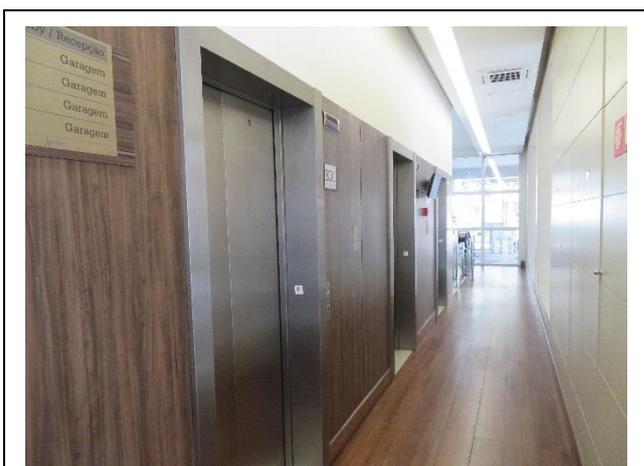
Pavimento térreo – 3(três) elevadores e hall de acesso.
